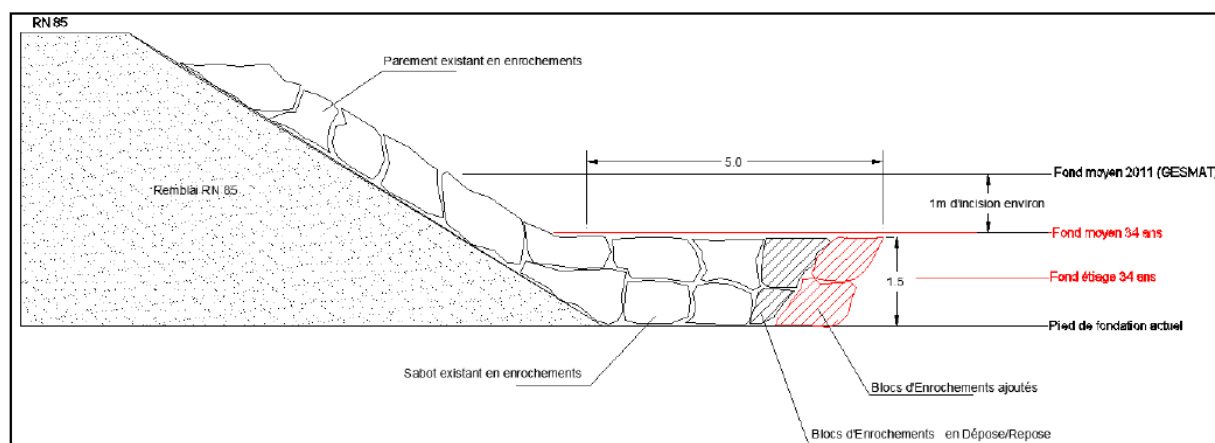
Coupe type de la protection de berge en rive droite à l'amont du seuil des eaux usées
